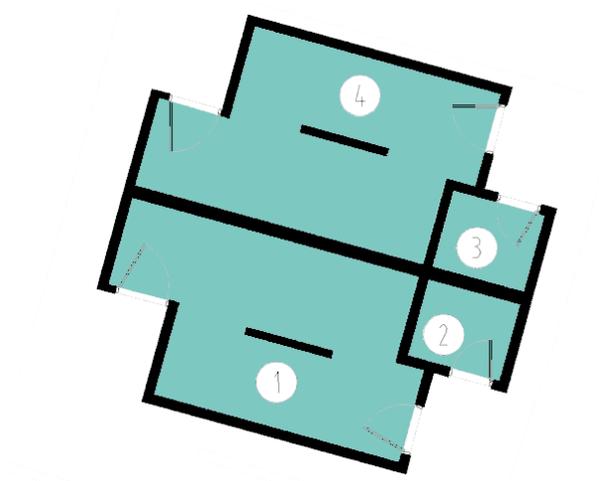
Planta tipo primer nivel Bloques No. 29,40 y 53
